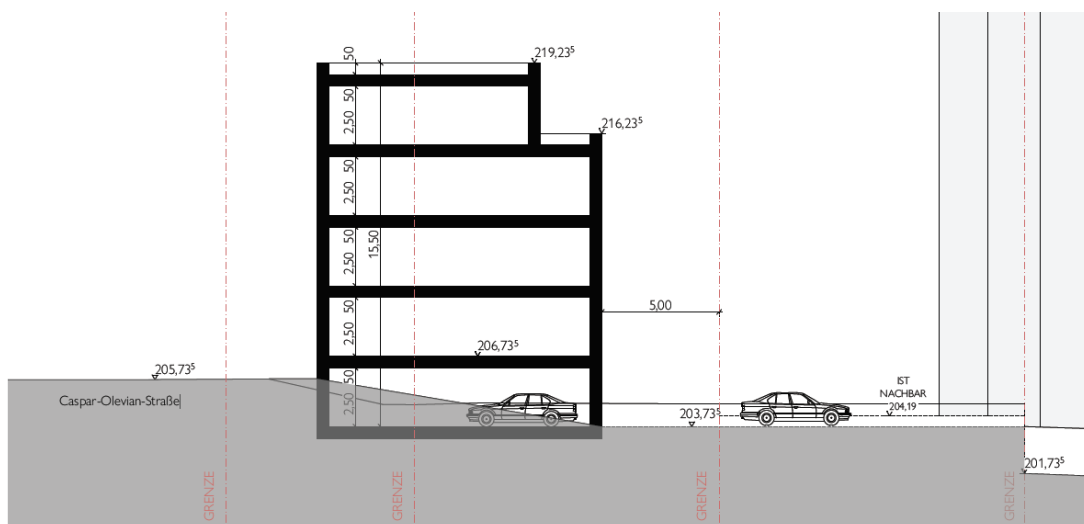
Gelände- und Gebäudeschnitt (Pasucha Klepzig Architekten, Stand 27.02.2023)
